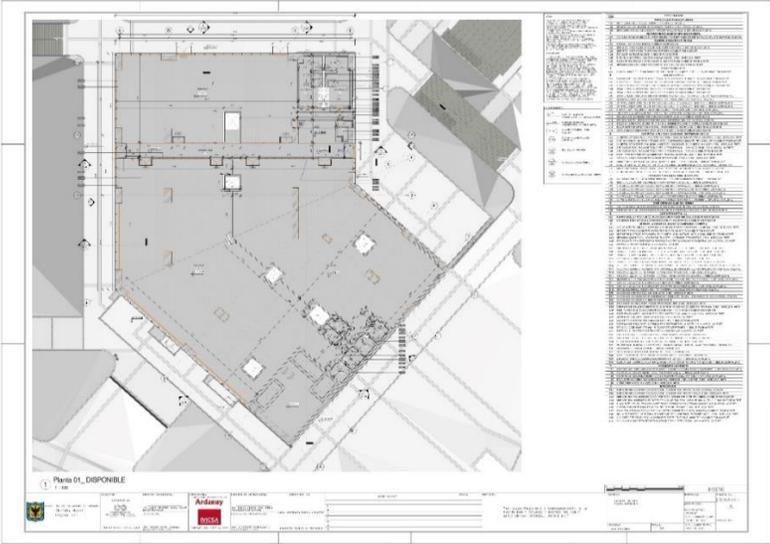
Planta Mezzanine estación intermedia - Victoria.
